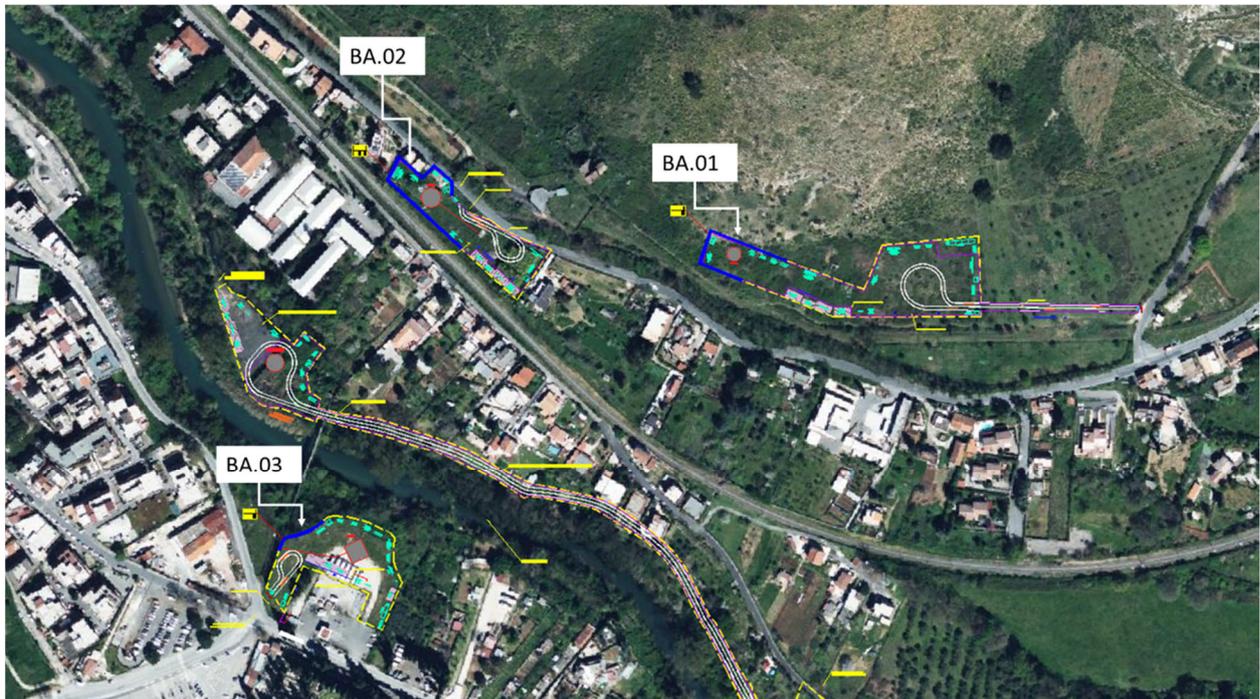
Stralcio planimetrico delle aree di cantiere e relativo posizionamento delle barriere antirumore
